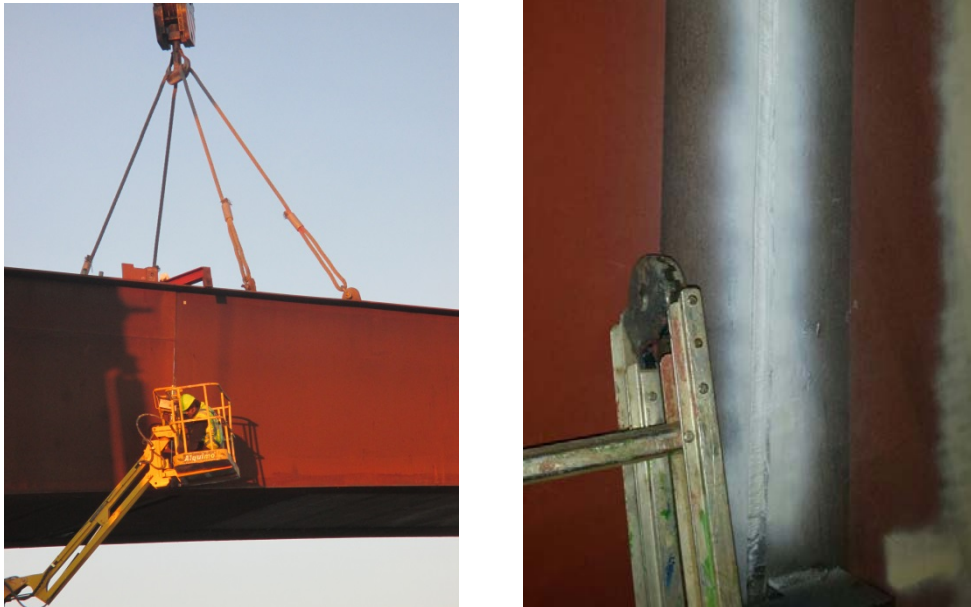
Soldadura de las almas antes de retirada de las grúas
